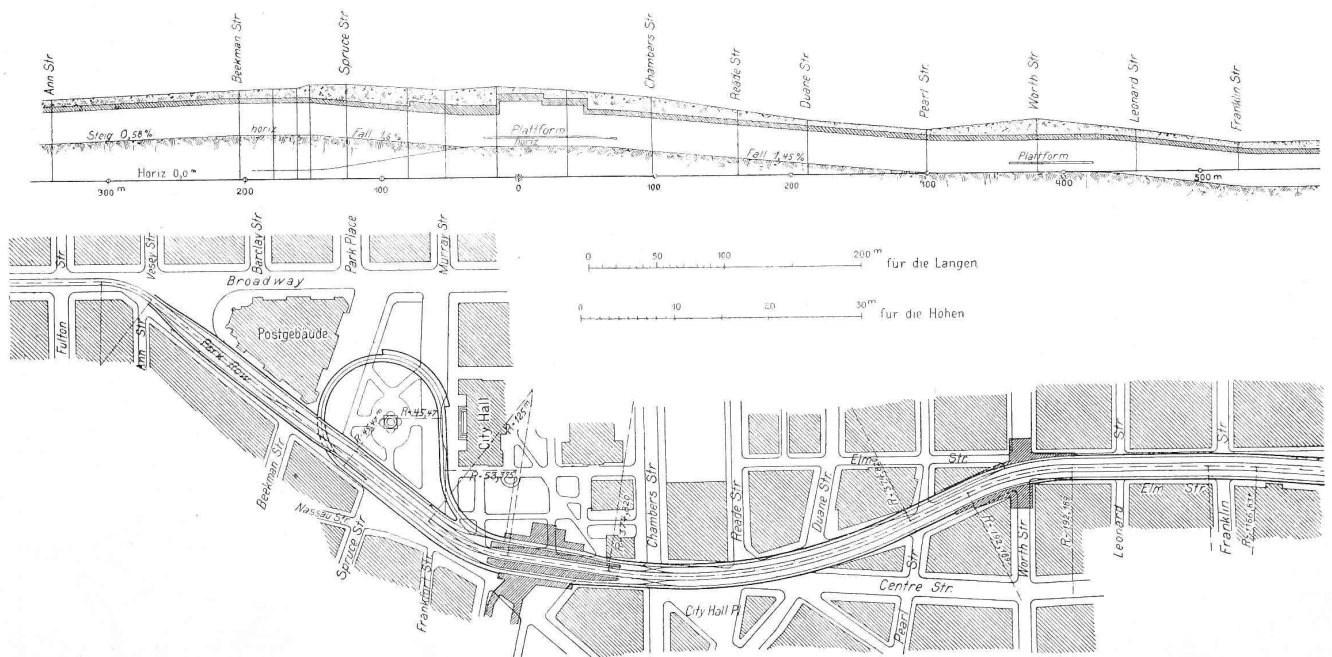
Untergrundbahn. — Lageplan und Längenprofil der Station «City Hall». — Masstab 1:5000 für die Längen, 1:725 für die Höhen.
